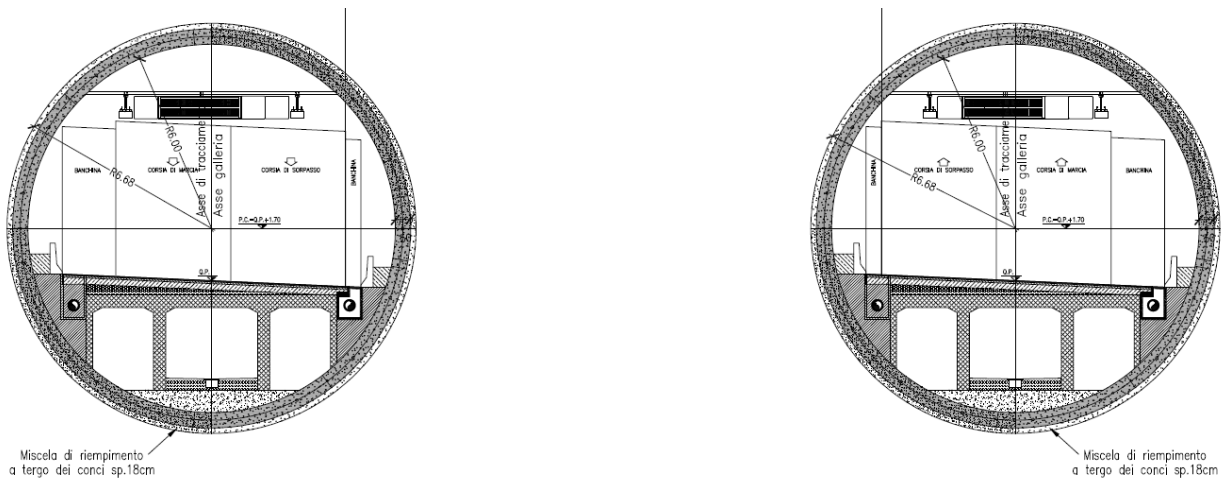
Sezione tipo galleria Citerna prevista in PP
